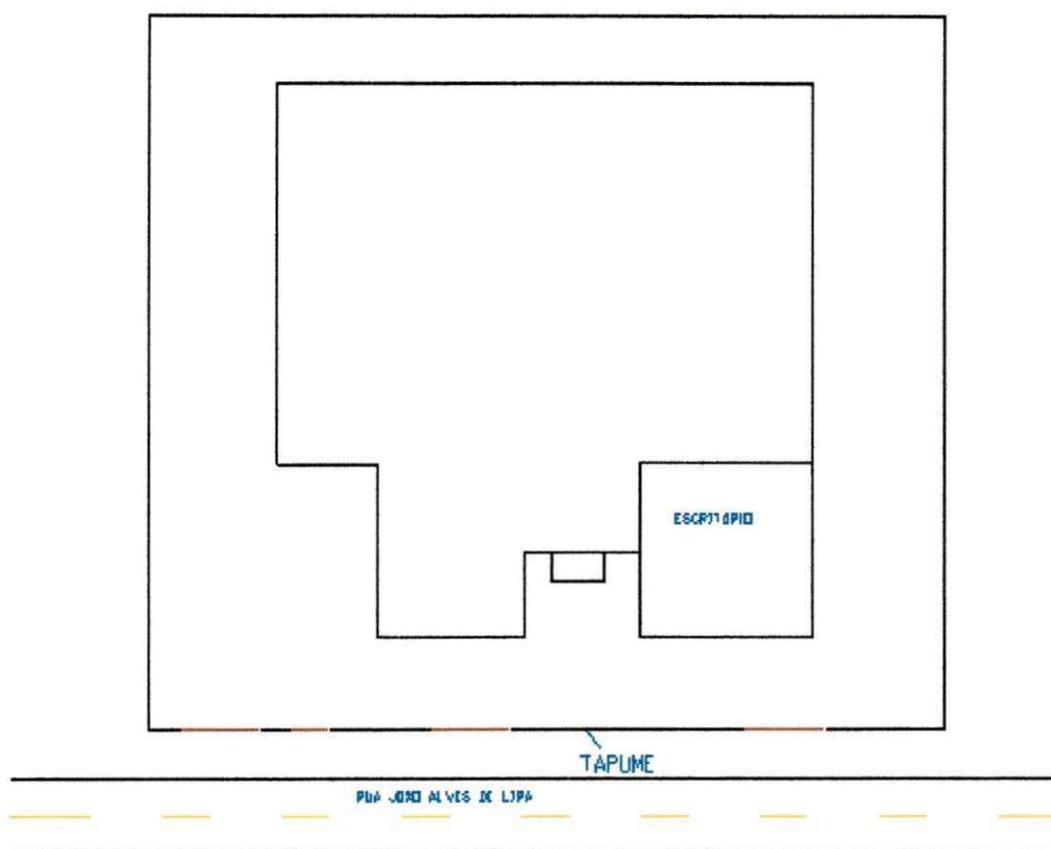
Esboço do canteiro de obras - 2ª Laje.
